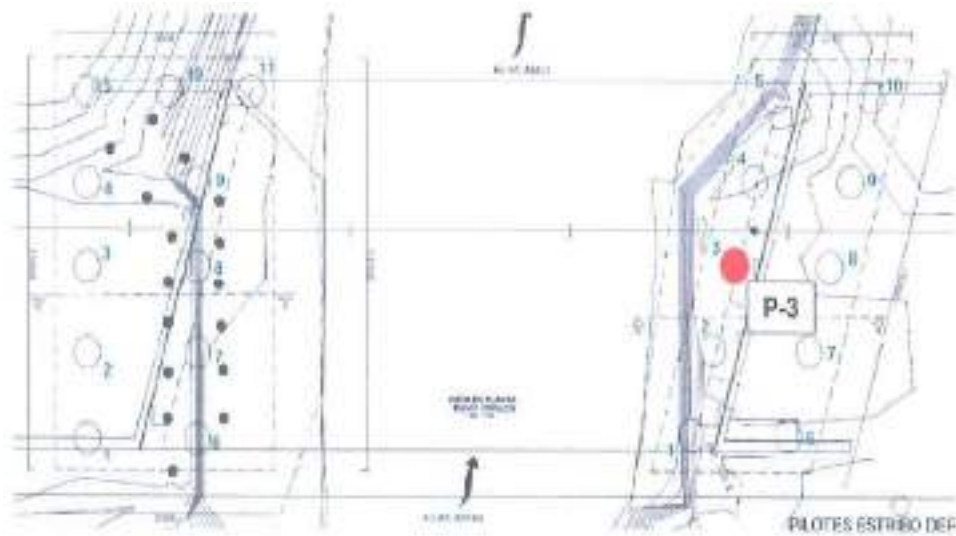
Plano en planta del Estribo Derecho – Puente Fortaleza.
